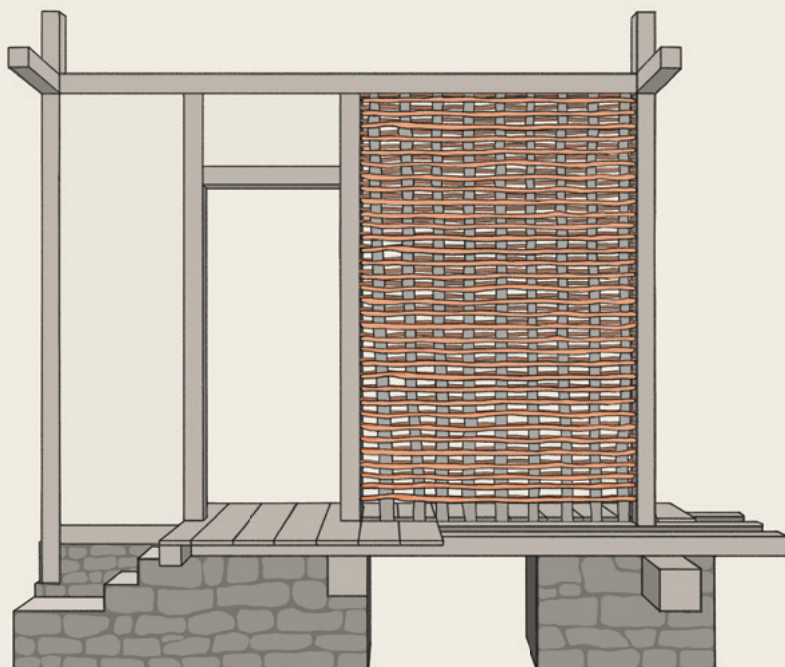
Esquema de construção de uma parede mista em que foi utilizada a técnica do pau a pique. Fonte: A Pique Arquitetura, 2025.
